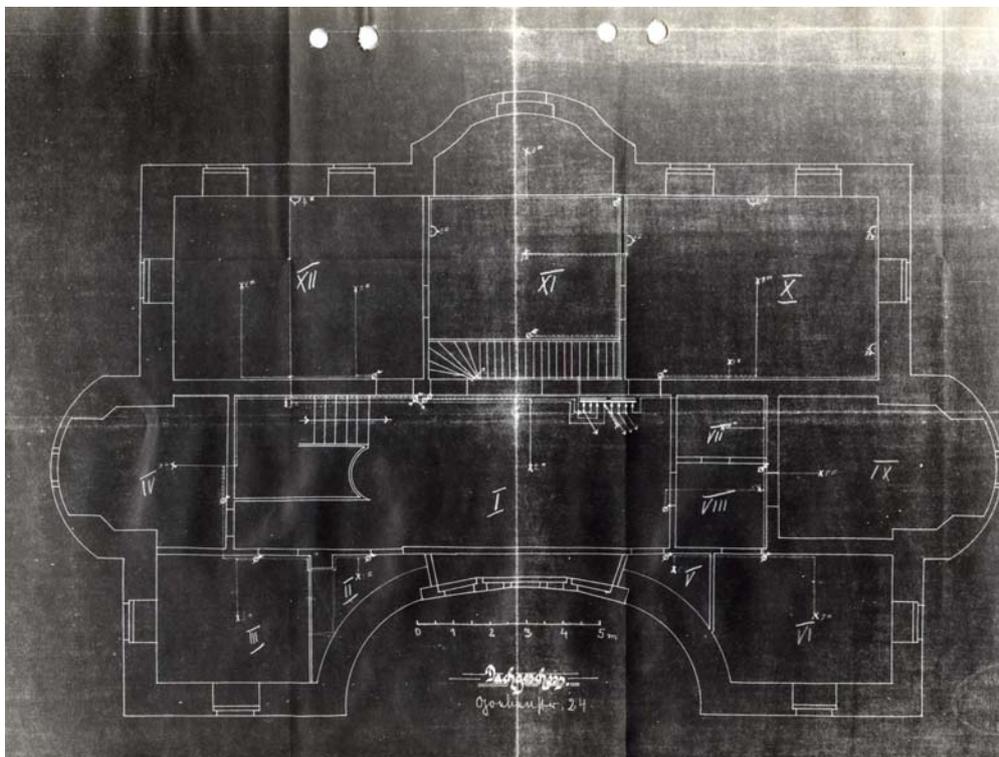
Haus Wichelhaus, Grundriss Dachgeschoss, ohne Jahresangabe, vor 1948
